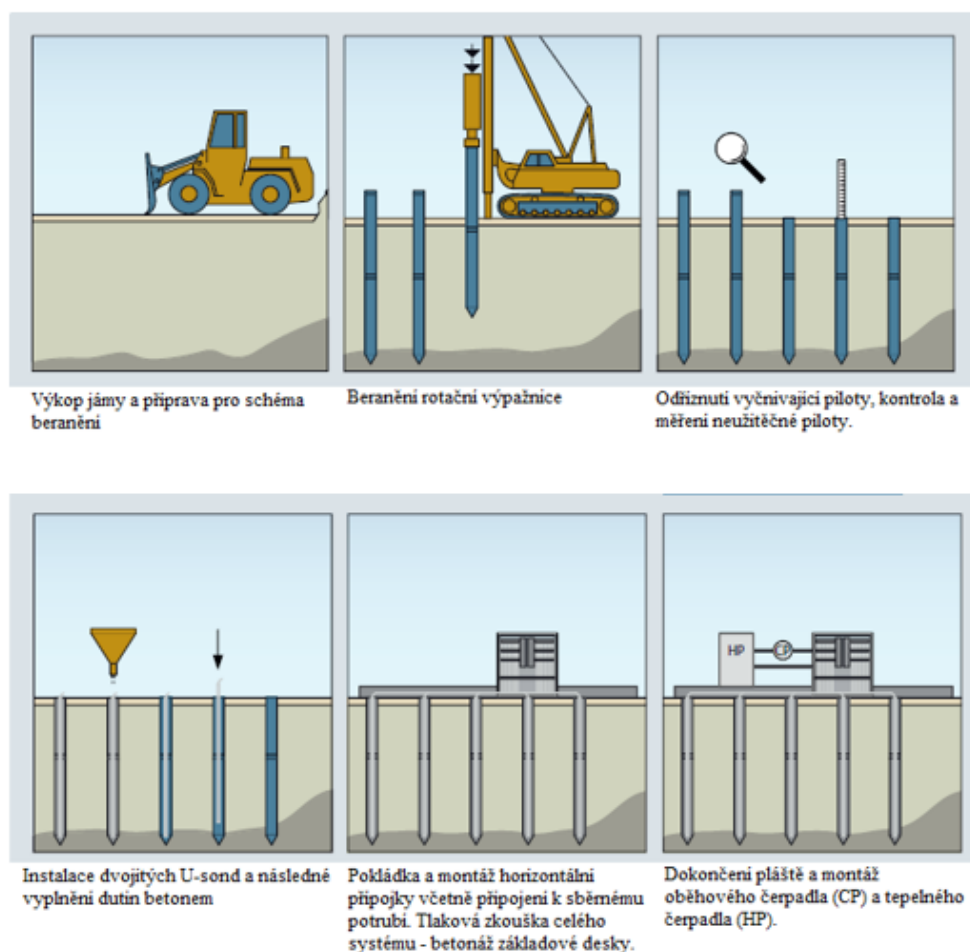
Sestava vrtaných pilot a prefabrikovaný beton vrtaných pilot [6]
